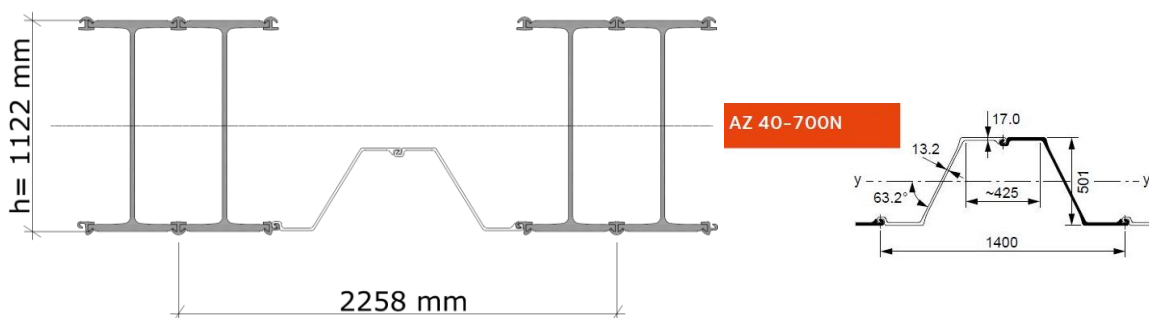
Detalle del perfil de la tablestaca principal de la sección 1 de la tablestaca trasera (derecha) de la Sección 1
